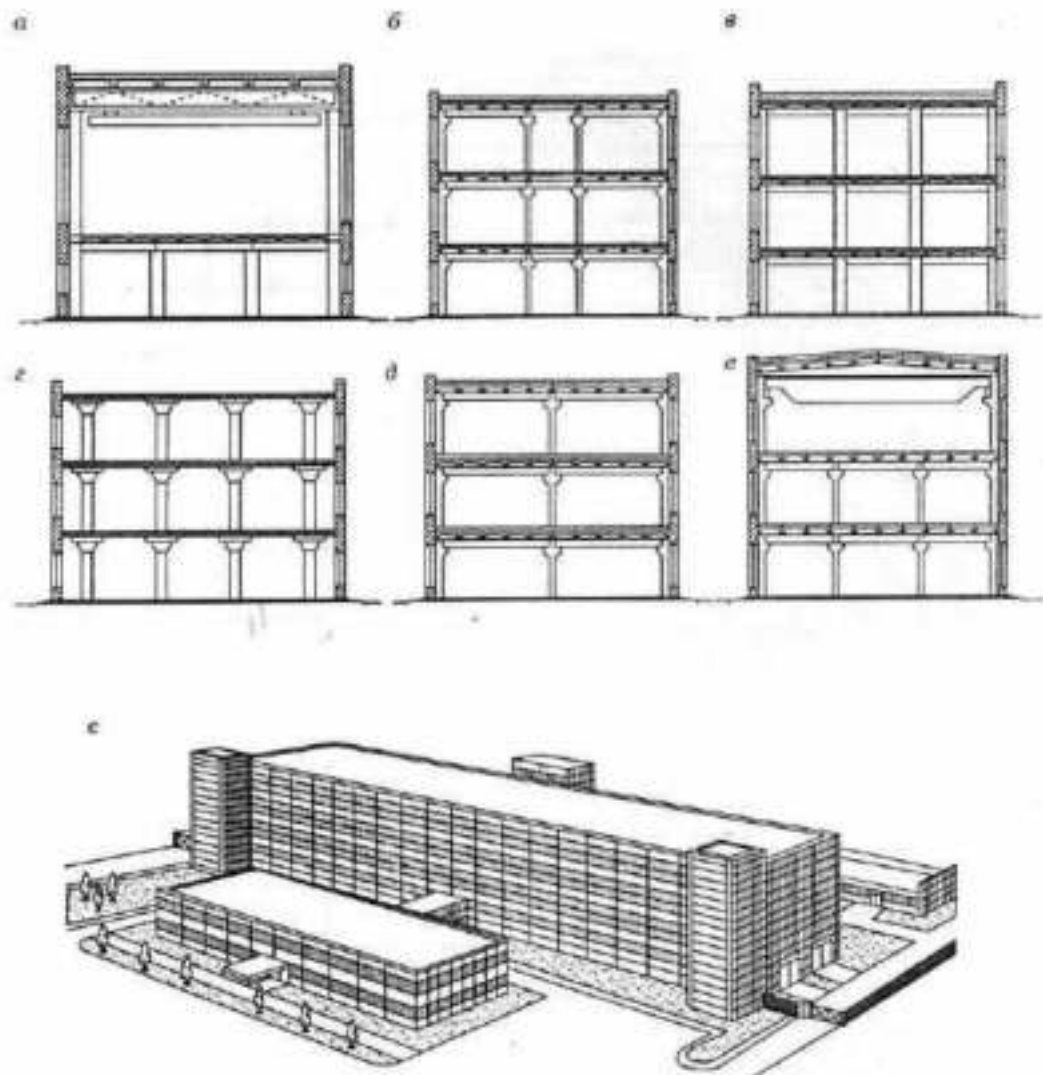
Види багатопверхових промислових будівель із збірним залізобетонним каркасом:
